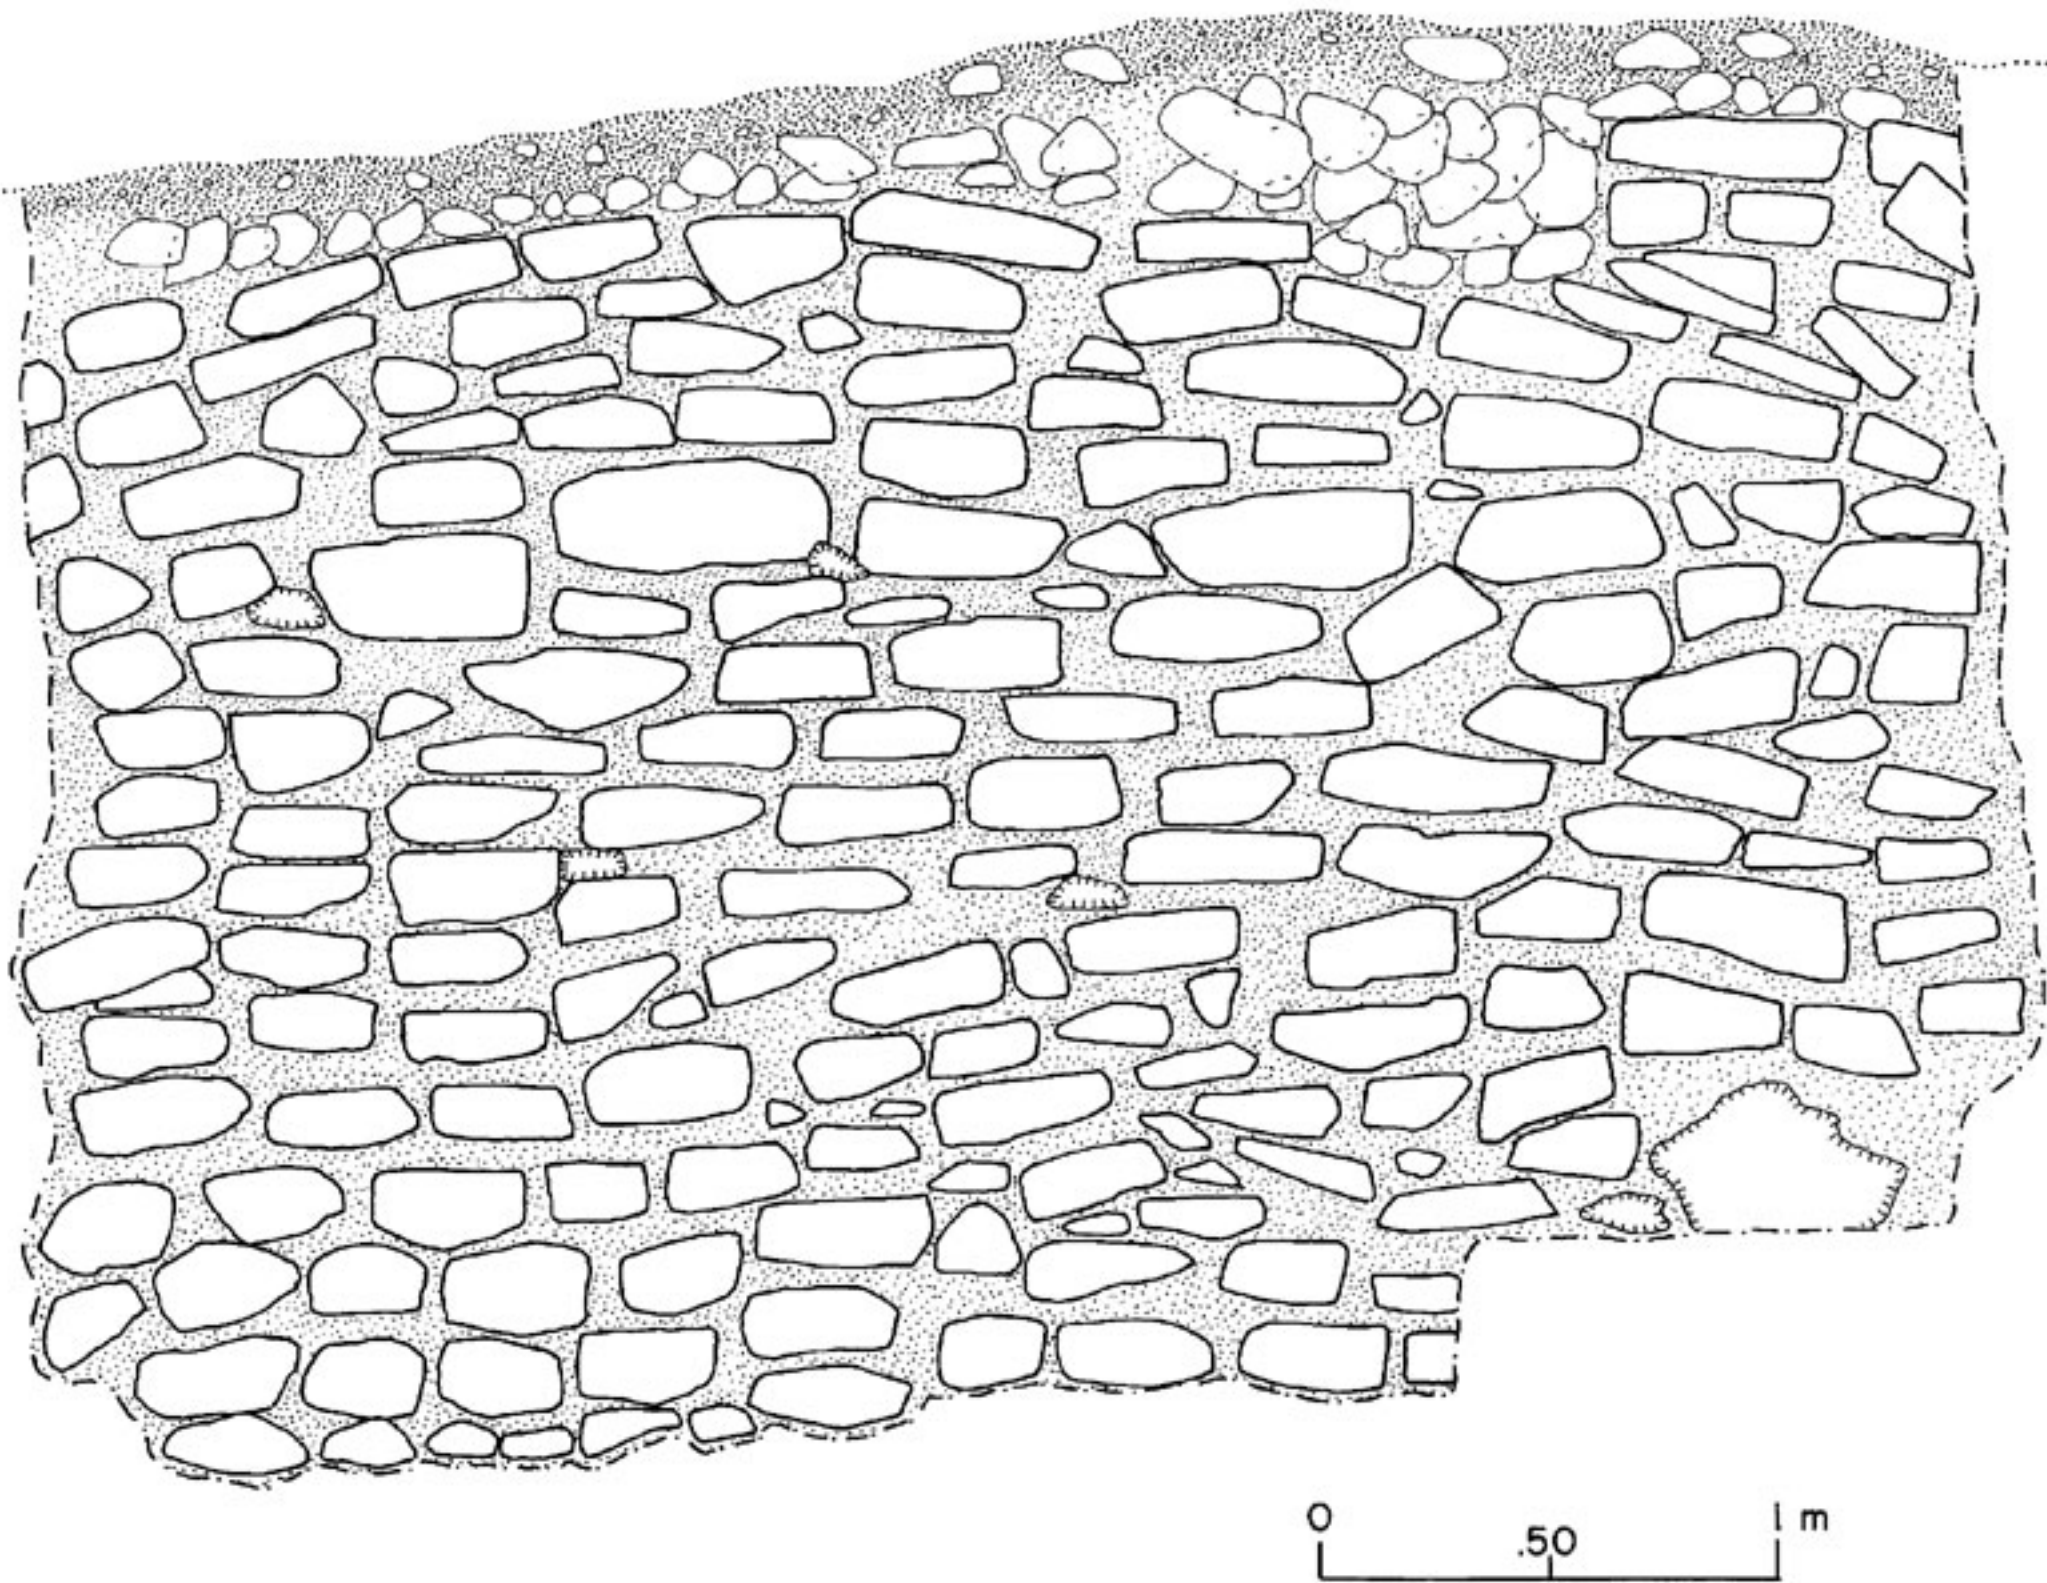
PN 58B-4 Elevación de talud en la parte superior de la Estructura R-16.
